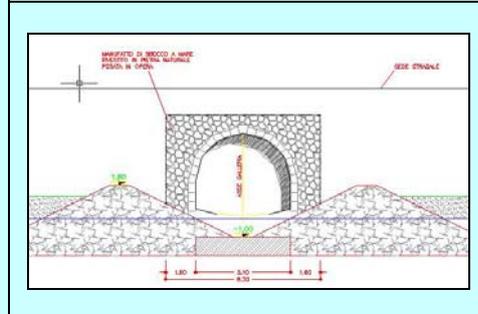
Prospetto Opera di Sbocco a Mare della Galleria Idraulica
